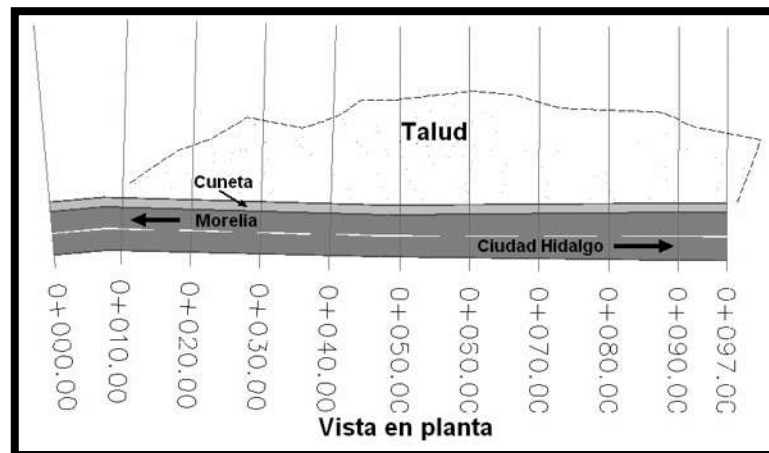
Vista en planta del talud "Los Cantiles 1".
